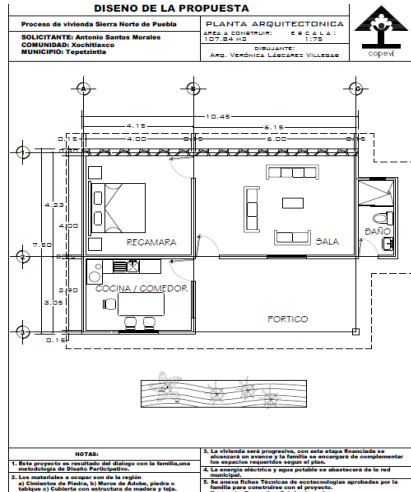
Planta arquitectónica prototipo “L” Imagen 5. Fachada y corte transversal prototipo “L”
